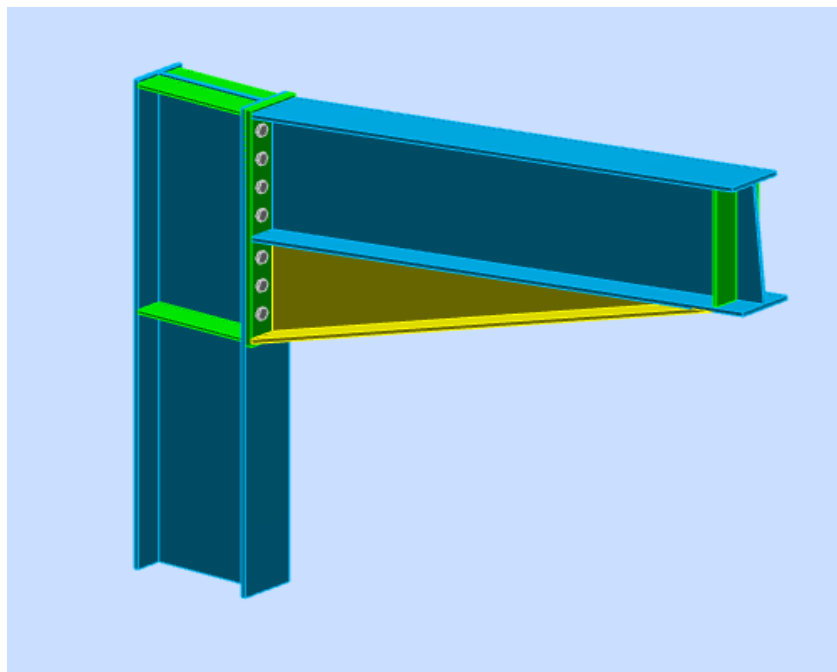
Vue3D de l'assemblage poteau poutre de rive
